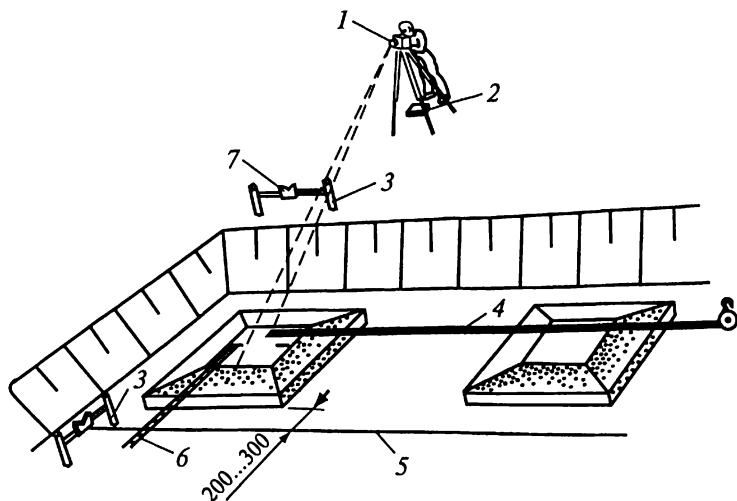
Перенесение осей на фундаментные блоки:
